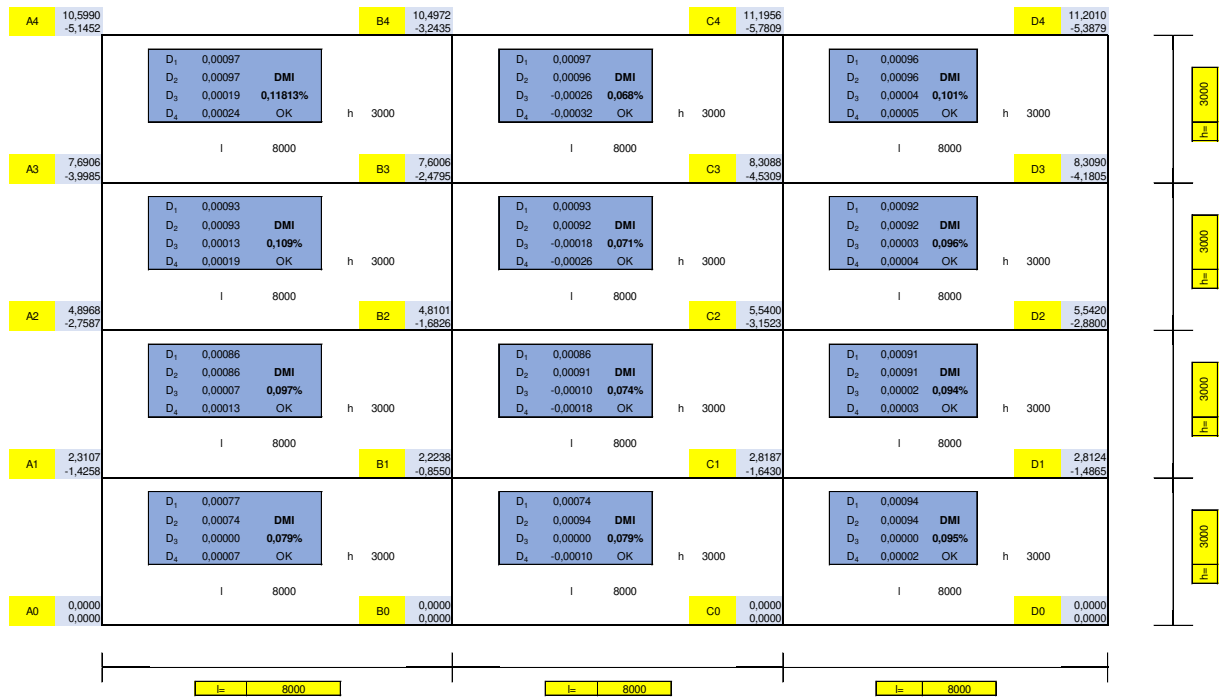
Avaliação das distorções do 13º ao 16º pavimento.
